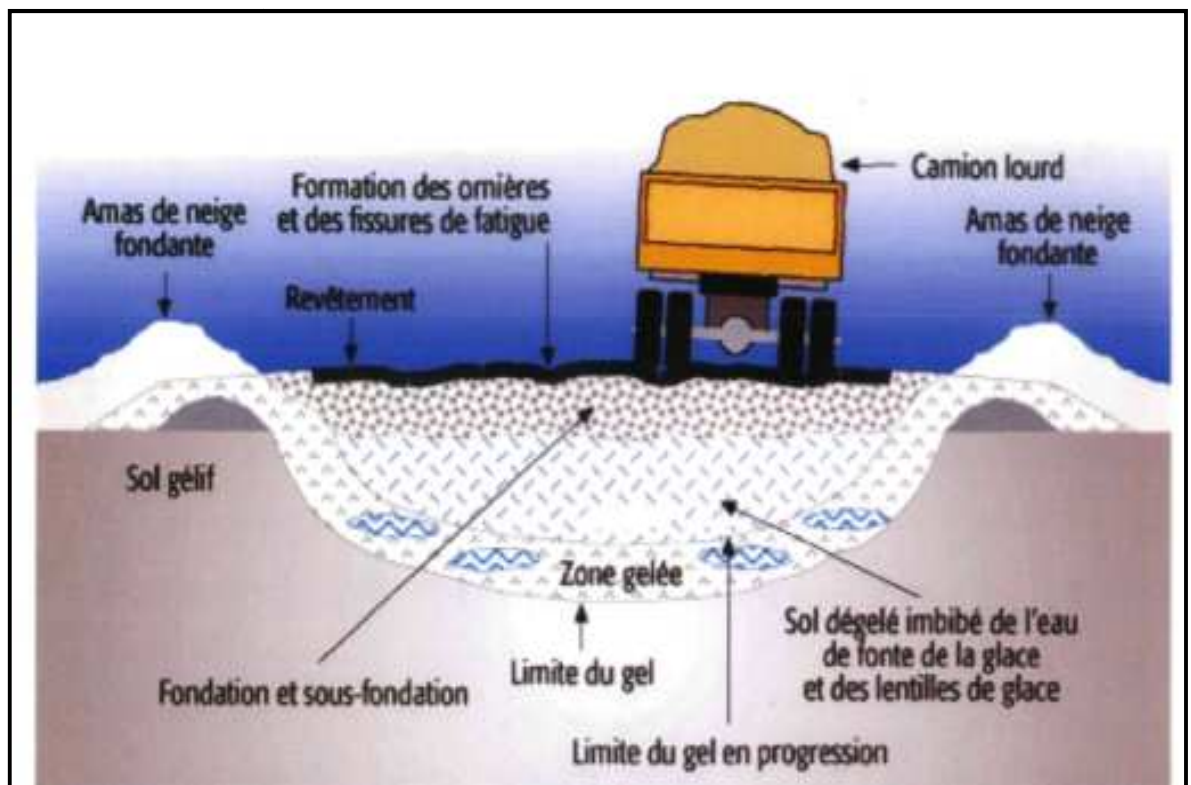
Action du dégel sur une chaussée routière (ALDALATIR, 2014)
